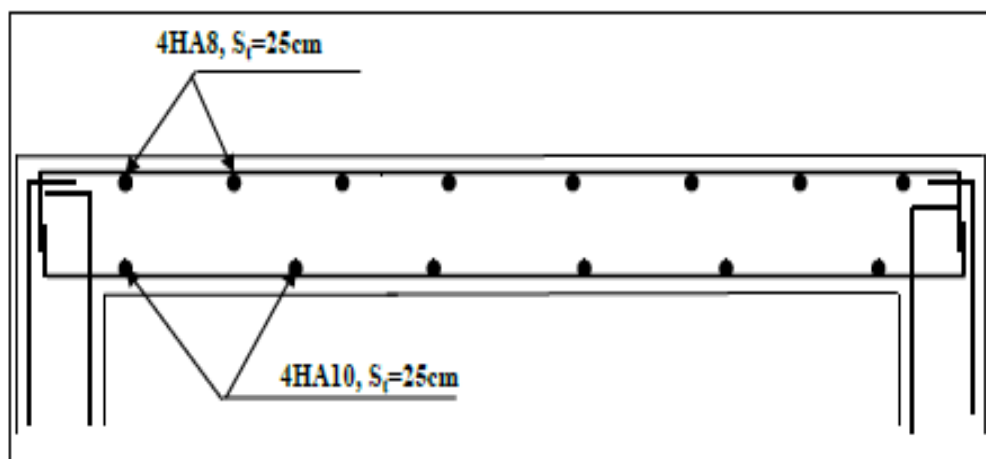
Plan de ferrailage de la salle machine suivant Y-Y
